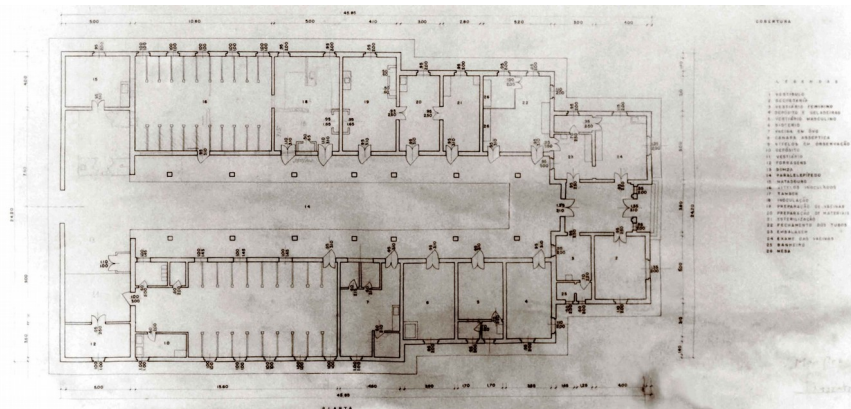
Planta baixa do Pavilhão Vacínico. Fonte: Acervo DPH/ COC/Fiocruz.
